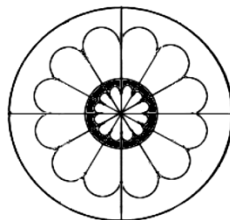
Prvi korak konstruiranja prozorske ruže [2]
